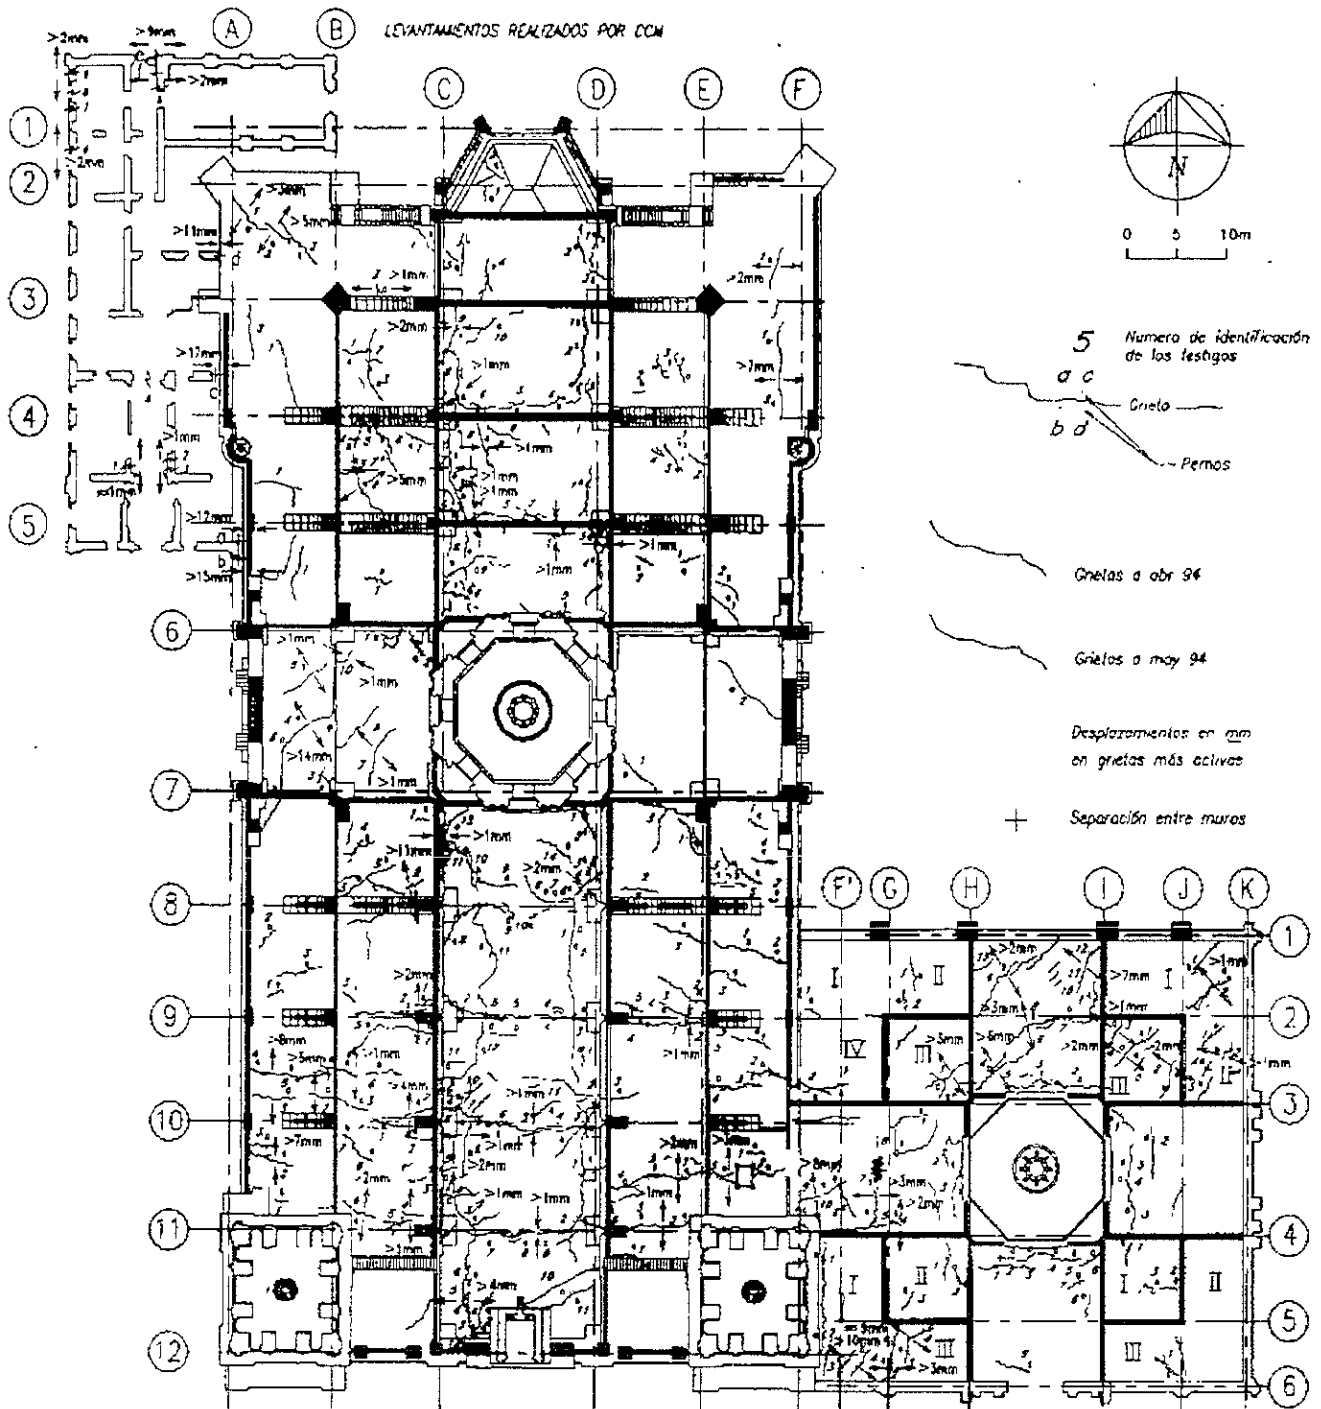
27 Configuración de grietas existentes en la cubierta
